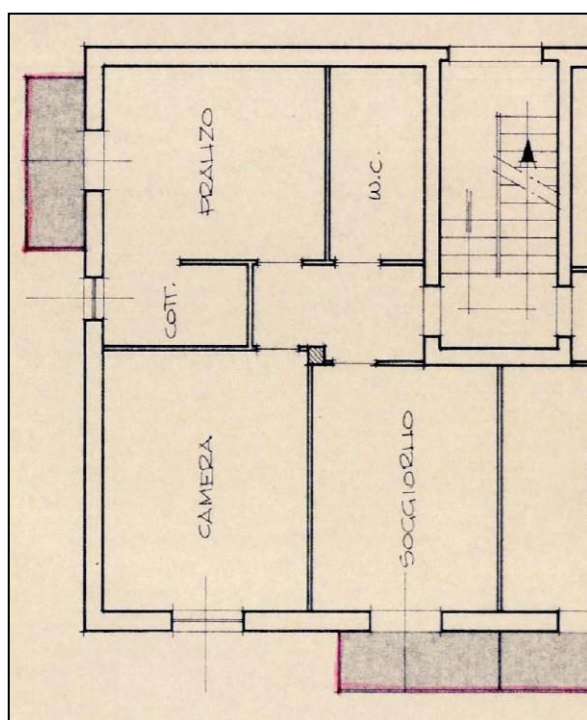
Planimetria allegata a C.E. dell'11.09.1990
